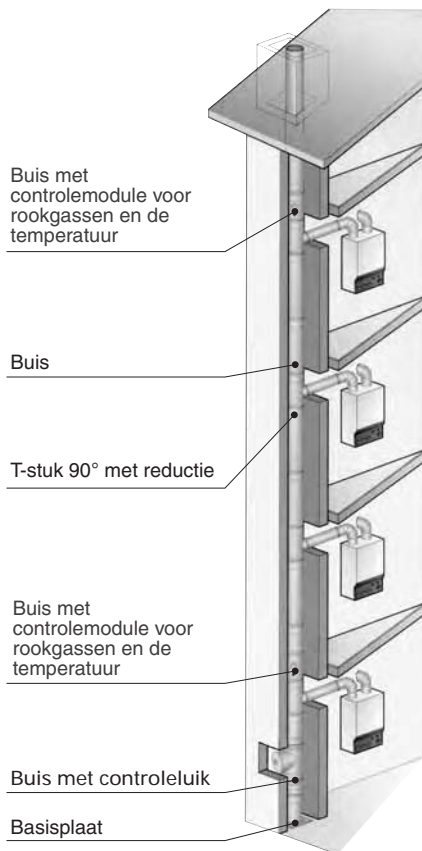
B CONDUIT DE FUMÉE COLLECTIF
